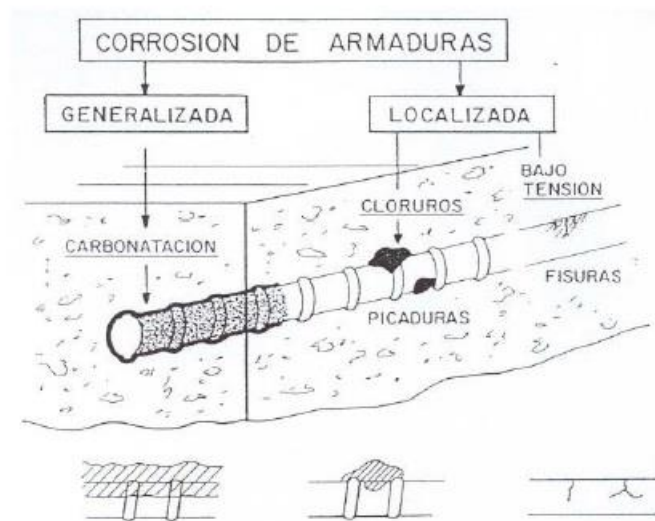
Tipos de corrosión de armaduras en el hormigón (ANDRADE, C., ALONSO, C., SARRIÁ, J Y CASTELLOTE, M., 1998)
